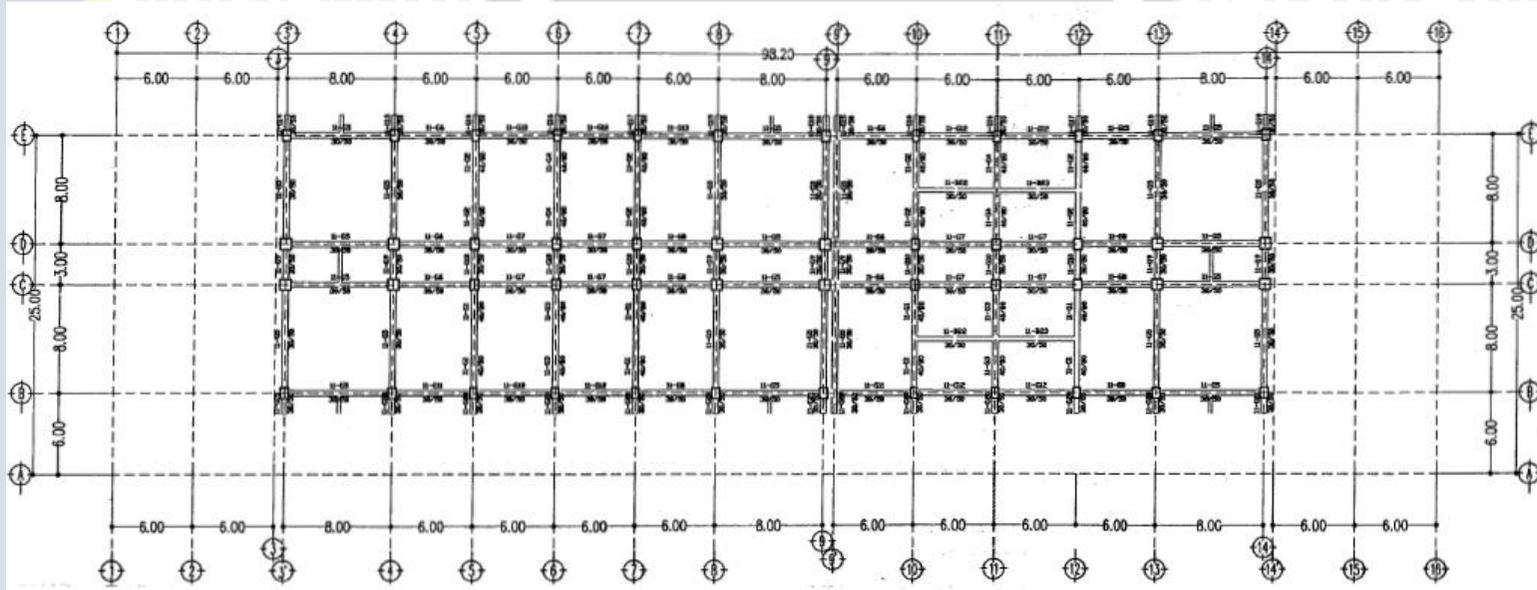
Denah Balok Lantai 1 GPB FK UB
